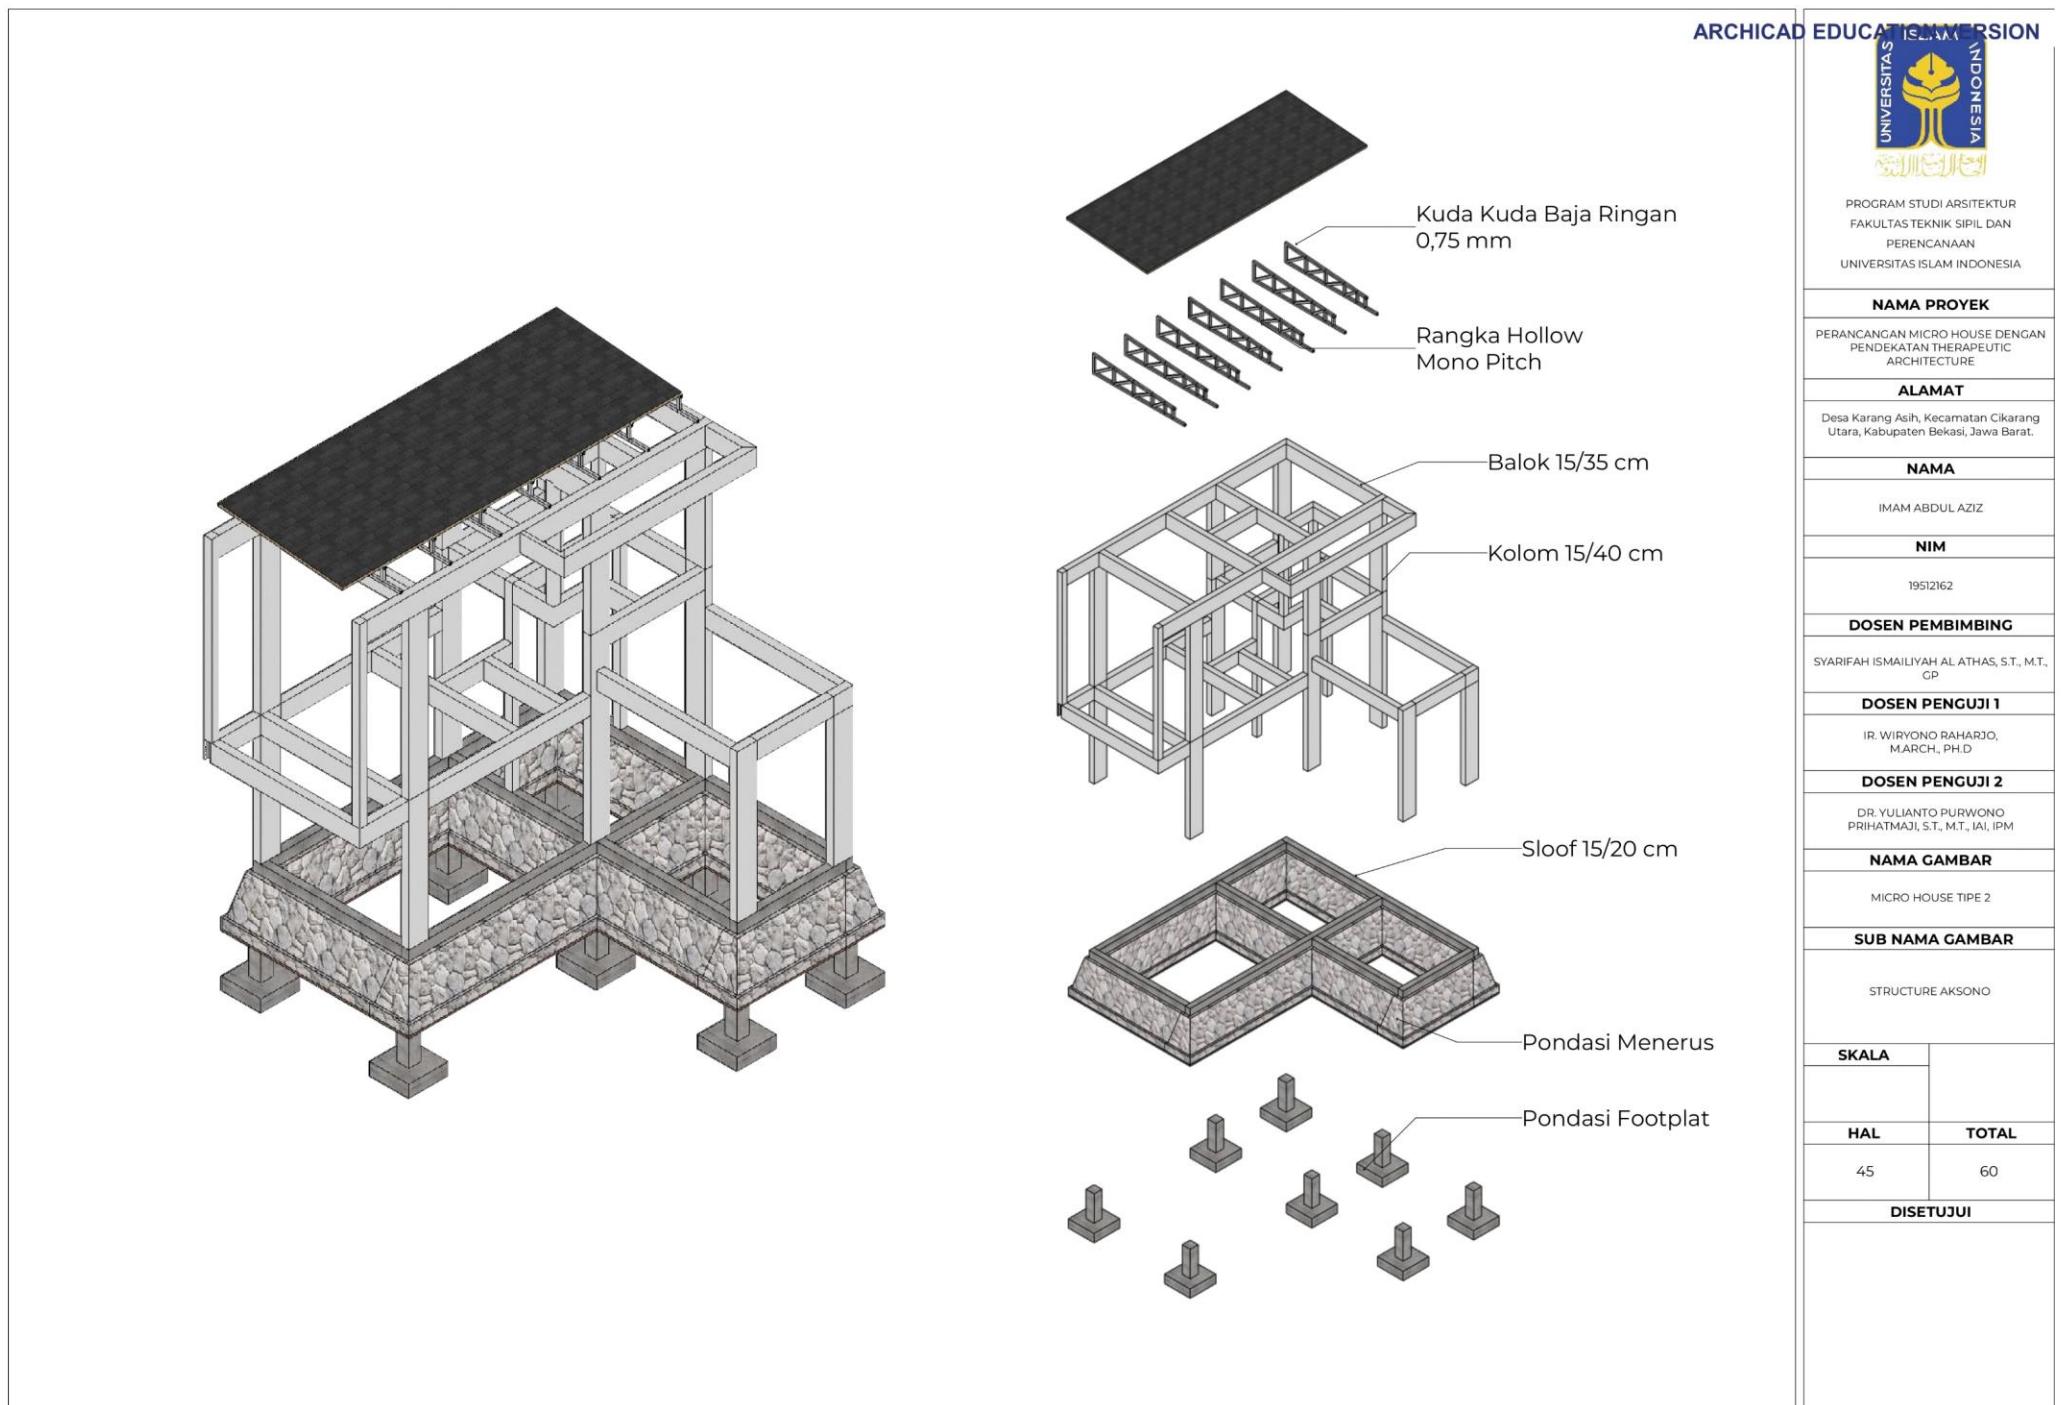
Rencana Struktur Micro House Tipe 2
